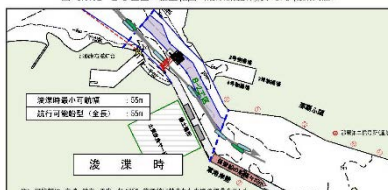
B-2 工区の施工範囲（潜水探査作業および浚渫共通）
